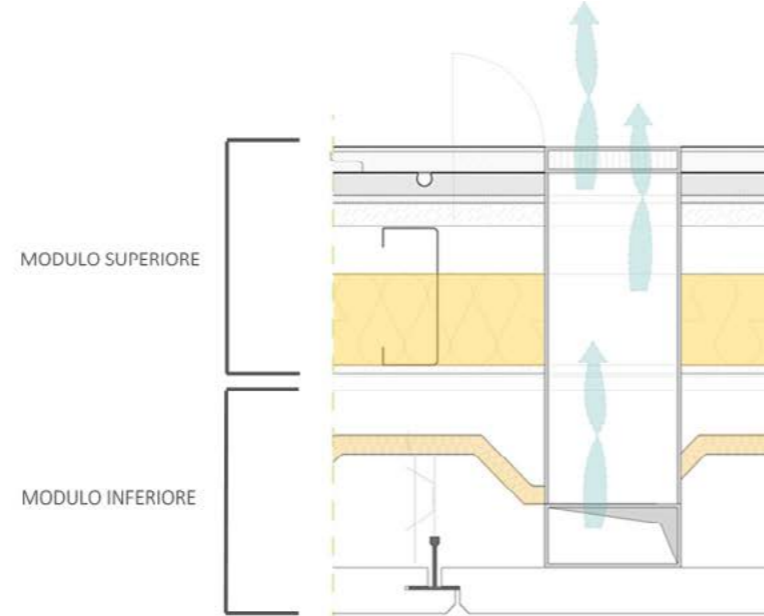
Giunto a bicchiere e connessione verticale degli impianti.
